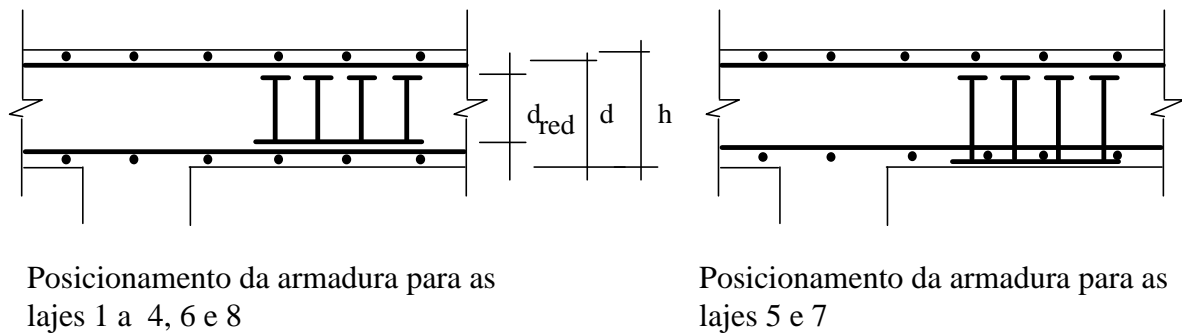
Posicionamento das armaduras de cisalhamento – (ANDRADE, 1999).
